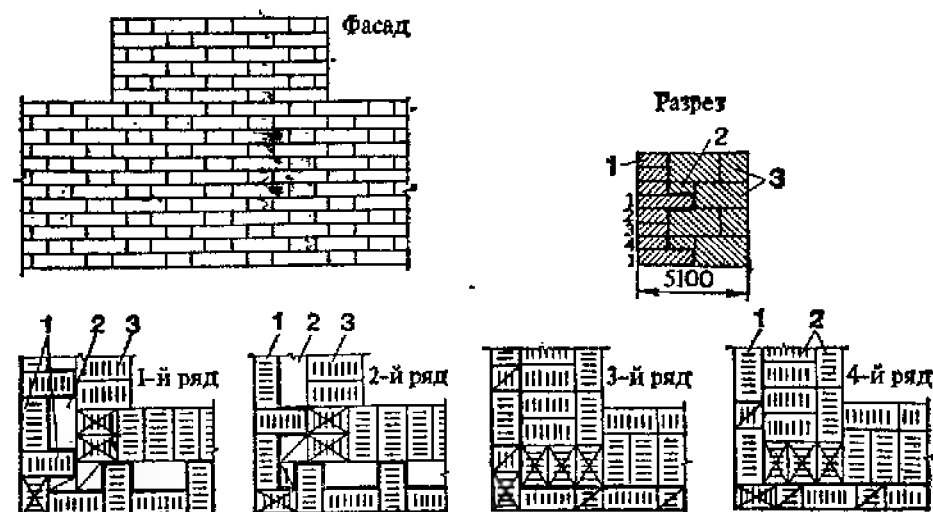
Перевязка лицевой кладки из кирпича с кладкой из керамических камней через один ряд камней (стена толщиной 510 мм):
